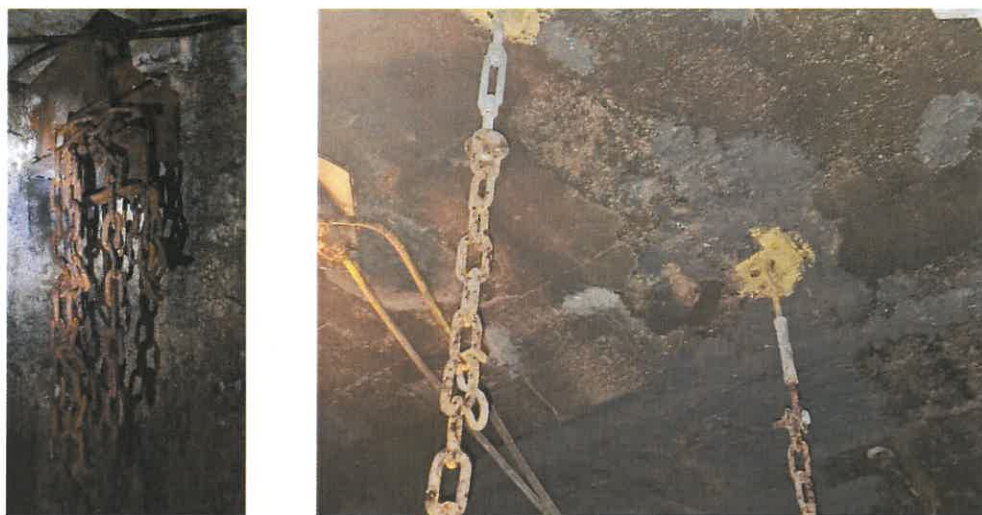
Strop poziom -57,3m – Korozja krat zabezpieczających otwory lejów podsadzkowych – zdjęcie wykonane w 2023 r.
